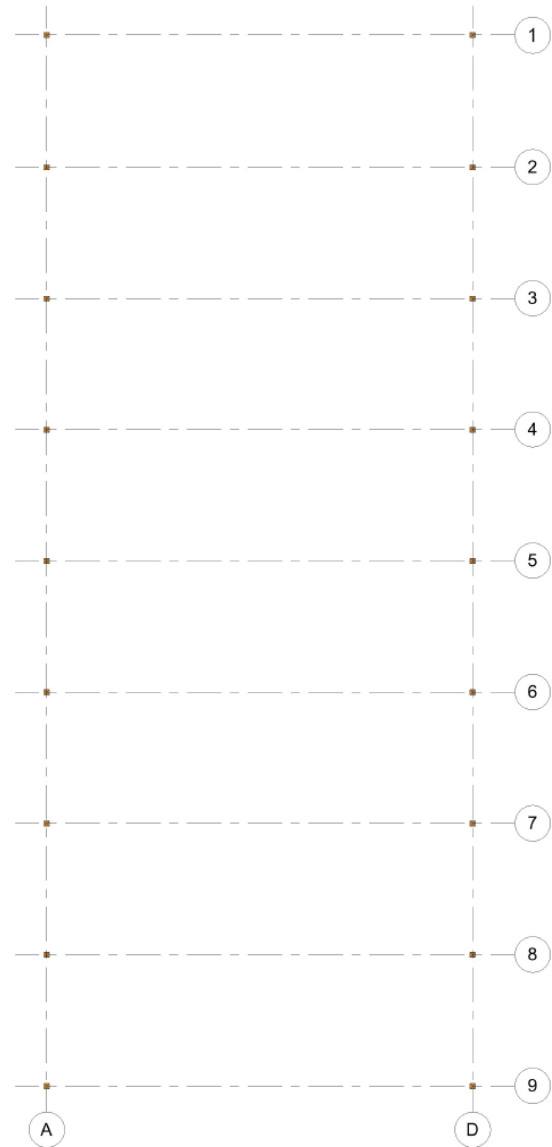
Aksekart plan 2 betong tildelt fra Veidekke
